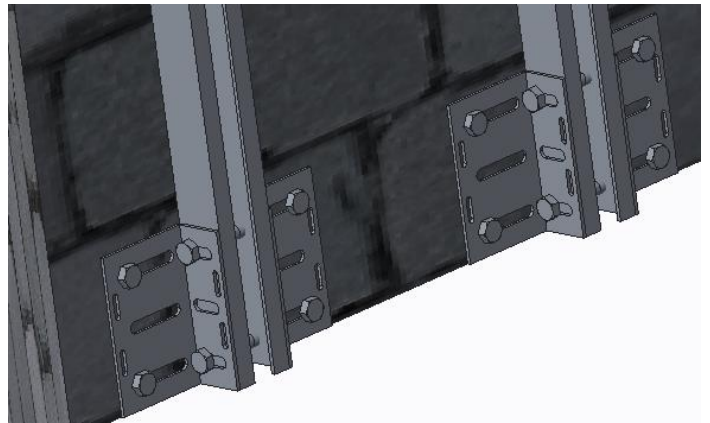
Vista en 3D del perfil C ancorat a la façana exterior amb les angulars.
